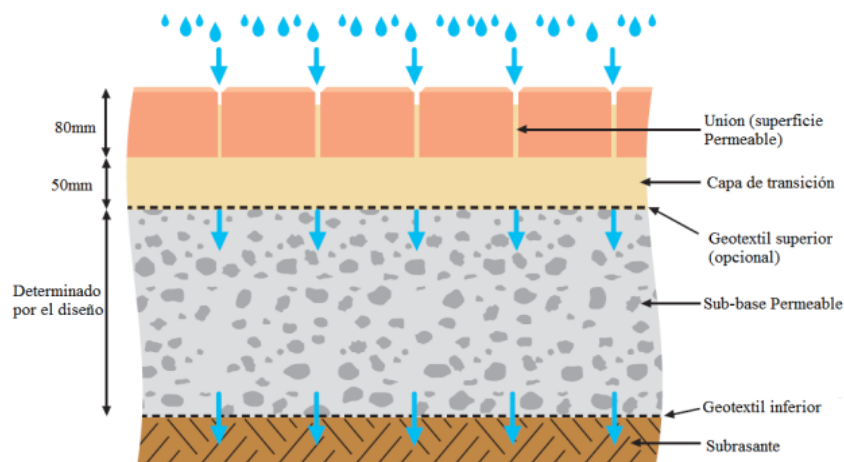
Estructura del pavimento permeable de total infiltración. (Adaptado de: Interpave, 2008).
